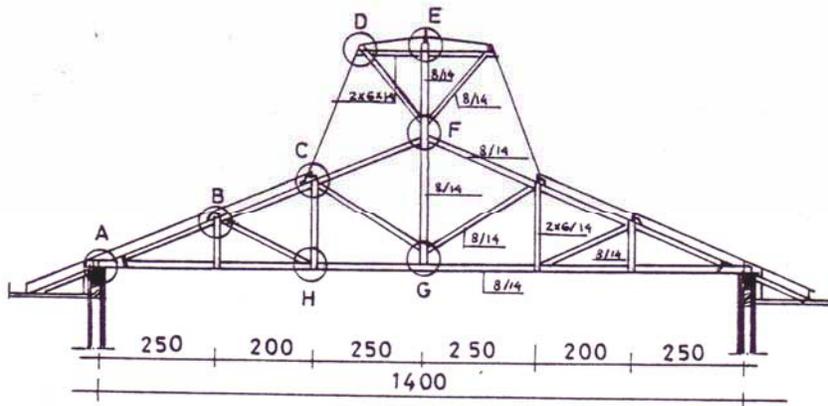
Ditail Konstruksi Kuda-kuda b
